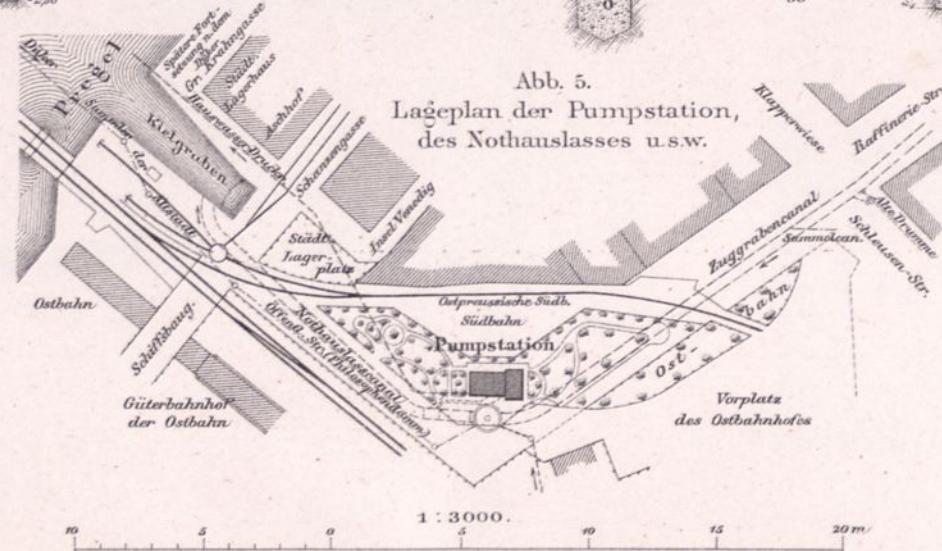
Lageplan der Pumpstation, des Nothauslasses u.s.w.
